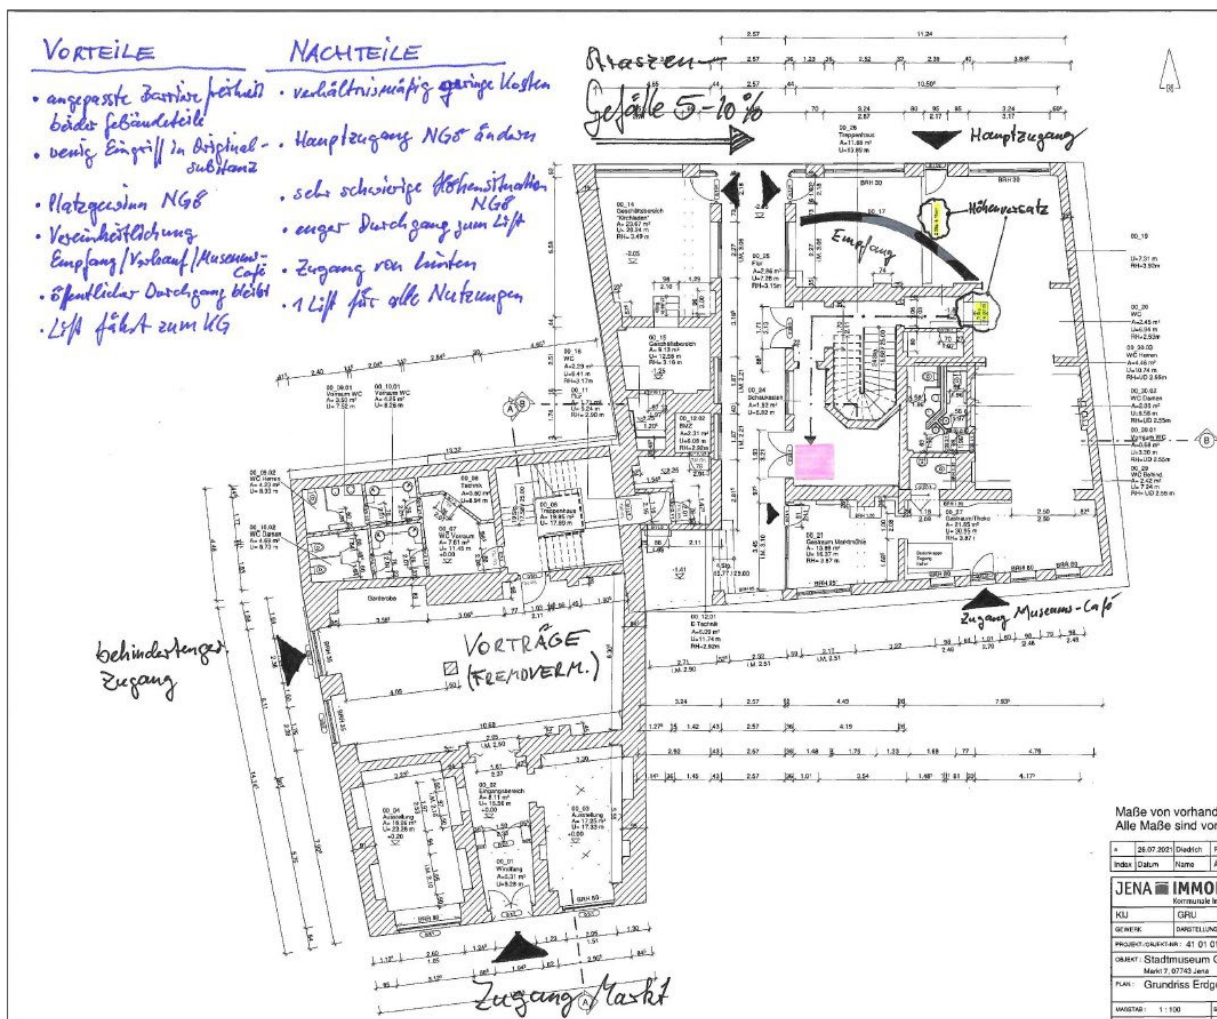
Grundriss Erdgeschoss, Positionierung Aufzug und Eingang zum Gebäude, Variante Treppenhaus Alte Göhre; Verfasser Wolfgang Winkler, Kommunale Immobilien Jena
